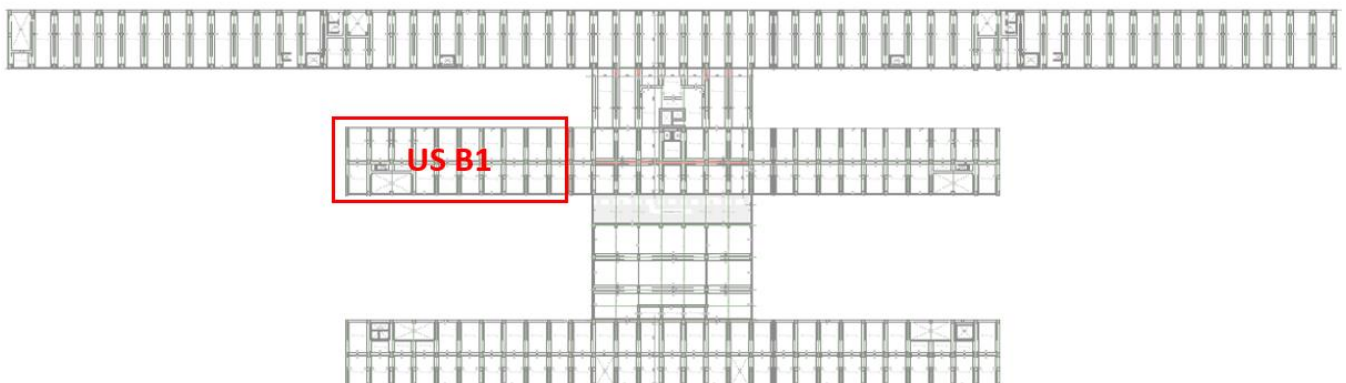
Pianta del Piano terra con inquadramento dell' Unità Strutturale B1, oggetto di studio.
